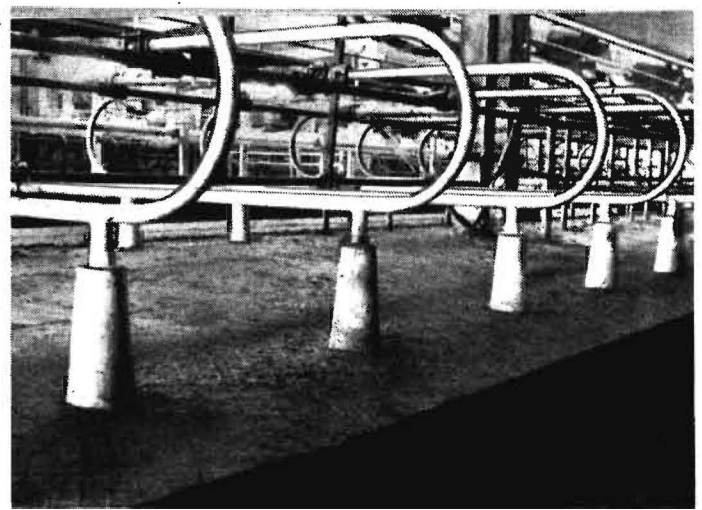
Betonelemente (Adapter) zur Aufnahme der raumstabilen und verspannten Standausrüstung
